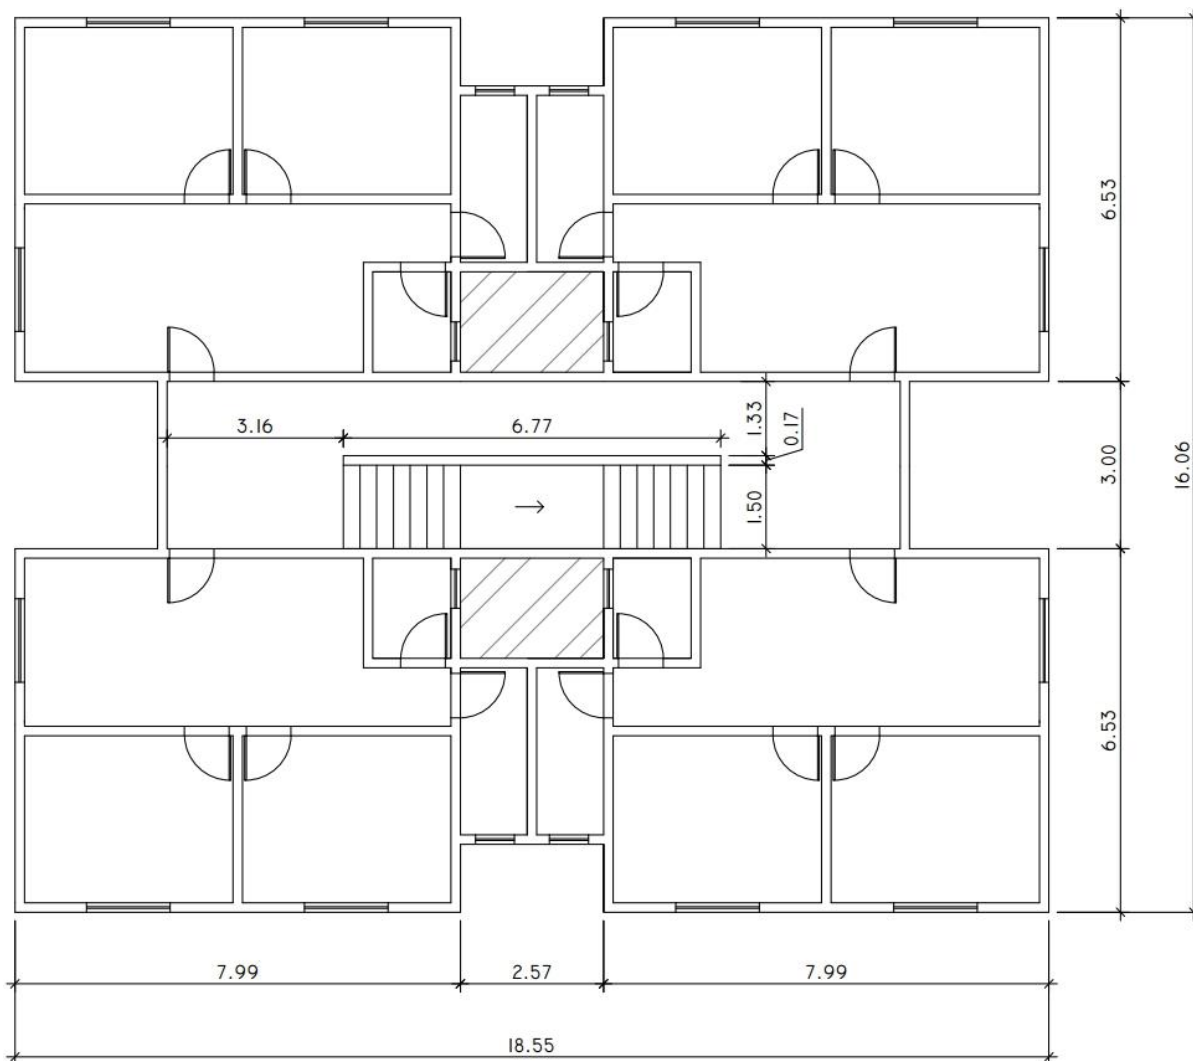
Planta baixa do pavimento tipo da edificação multifamiliar.
